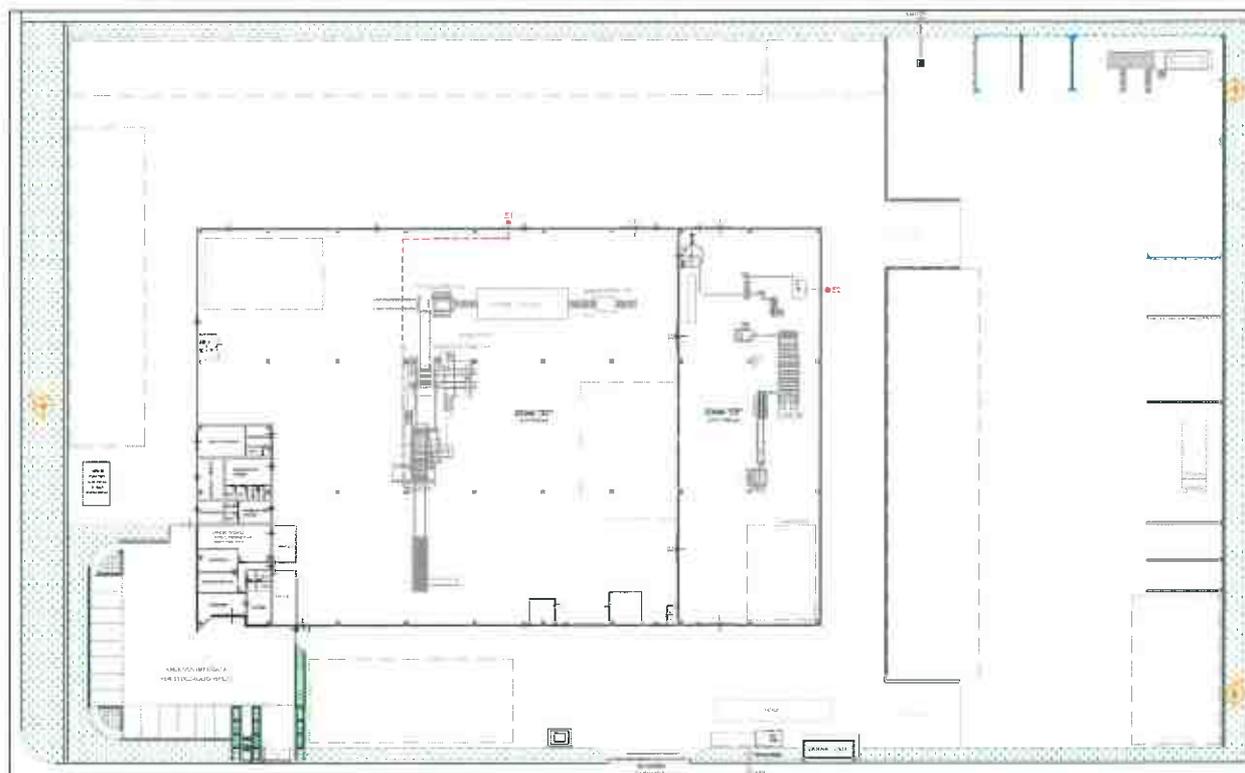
Planimetria punti di emissione nuova configurazione (da Tav. 13 allegata allo SPA)
